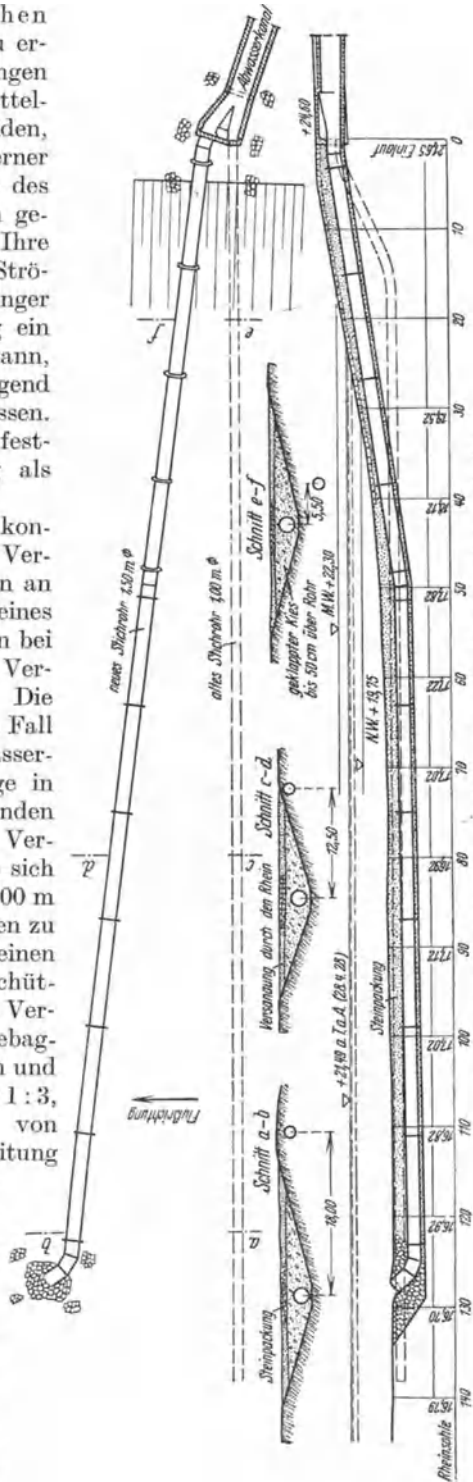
Ausbuchtung des Ausmündungsrohres des Hauptsummers in Duisburg.
